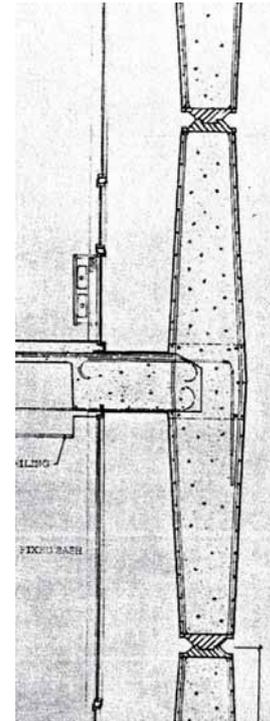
Façade de la Banque Lambert, détail des connections entre deux éléments de façade et entre les éléments de façade et le plancher [15].
